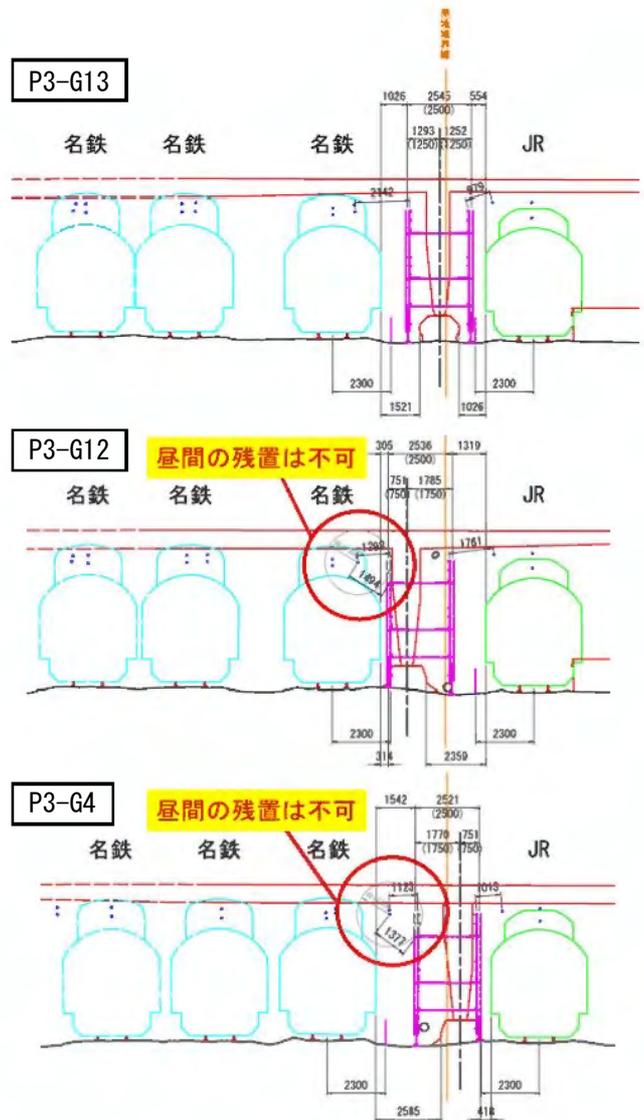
名鉄架線と橋脚部の単管足場との離隔図(断面図)
